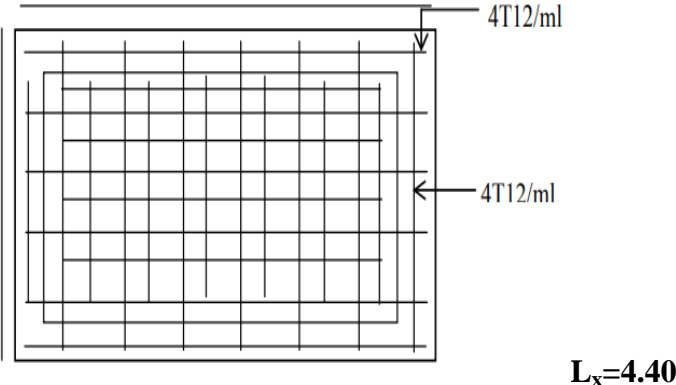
Dessin Ferrailage inférieur du panneau de la dalle pleine
